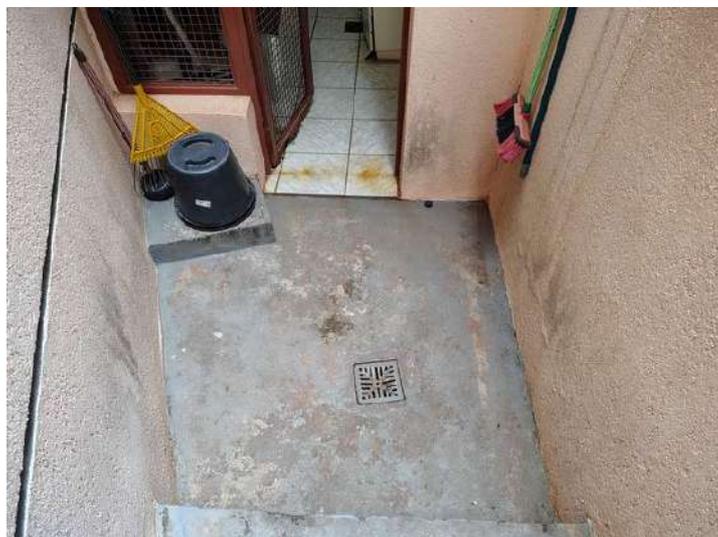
Lavanderia – Área externa – Deterioração do revestimento do piso
